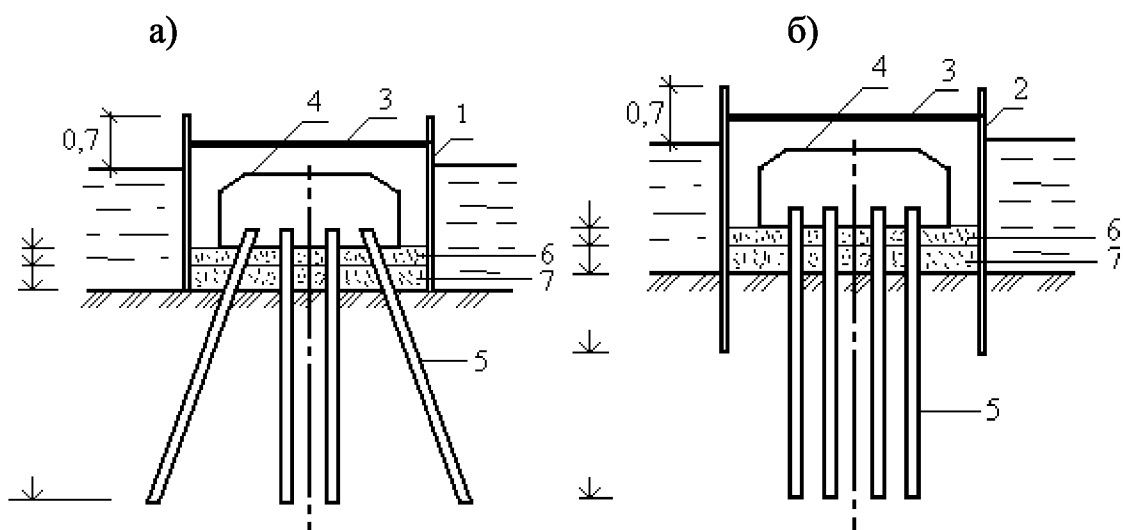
Ограждения котлованов на акватории при сооружении ростверка, расположенного над грунтом:
